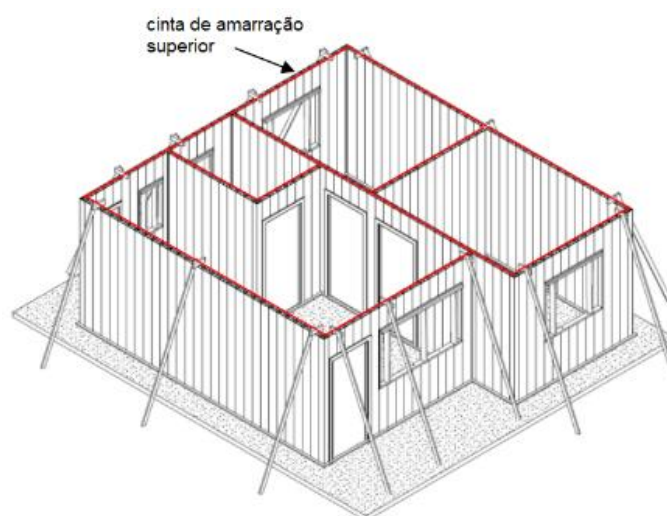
Ilustração da armadura horizontal na região superior dos painéis de PVC rígido - cinta de amarração superior. (Sem escala).
